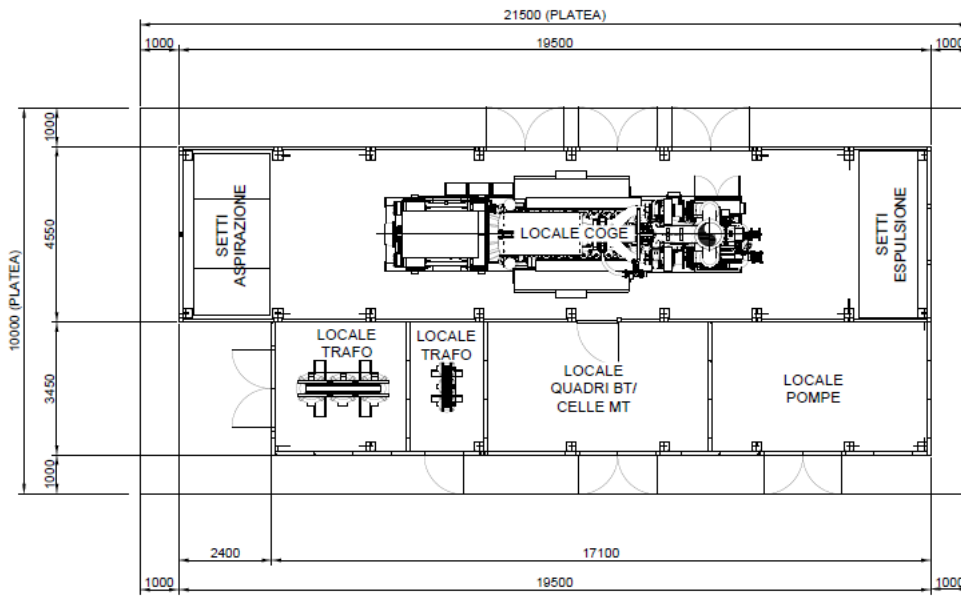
Stralci elaborato "2-N970Q911\_MG-001\_01\_Layout impianto di cogenerazione".
